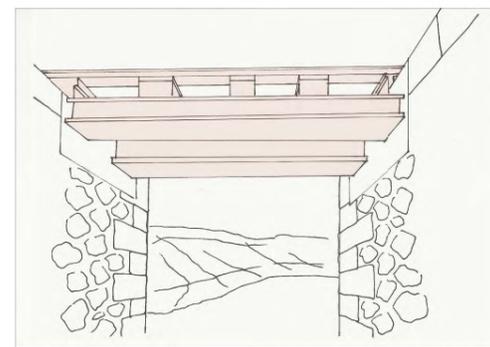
Pormenor do caderno da viagem- Ponte Ferroviária
